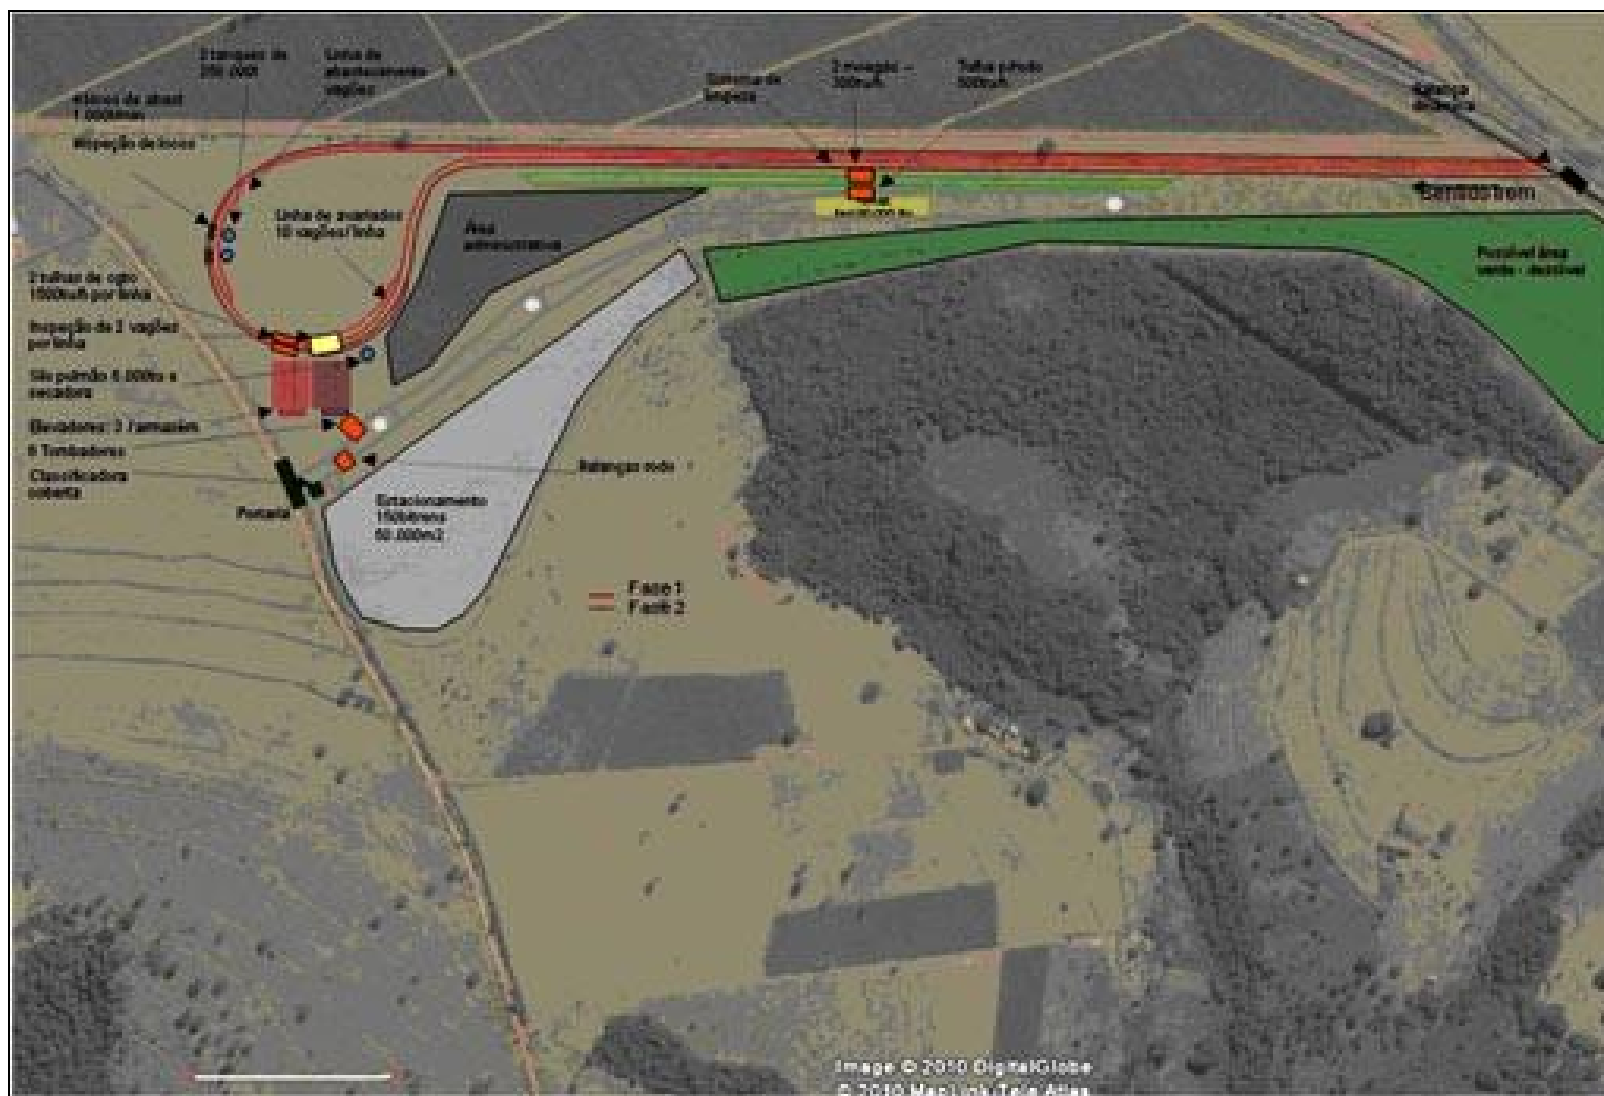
Terminal Intermodal em Construção em Araguari (MG).
